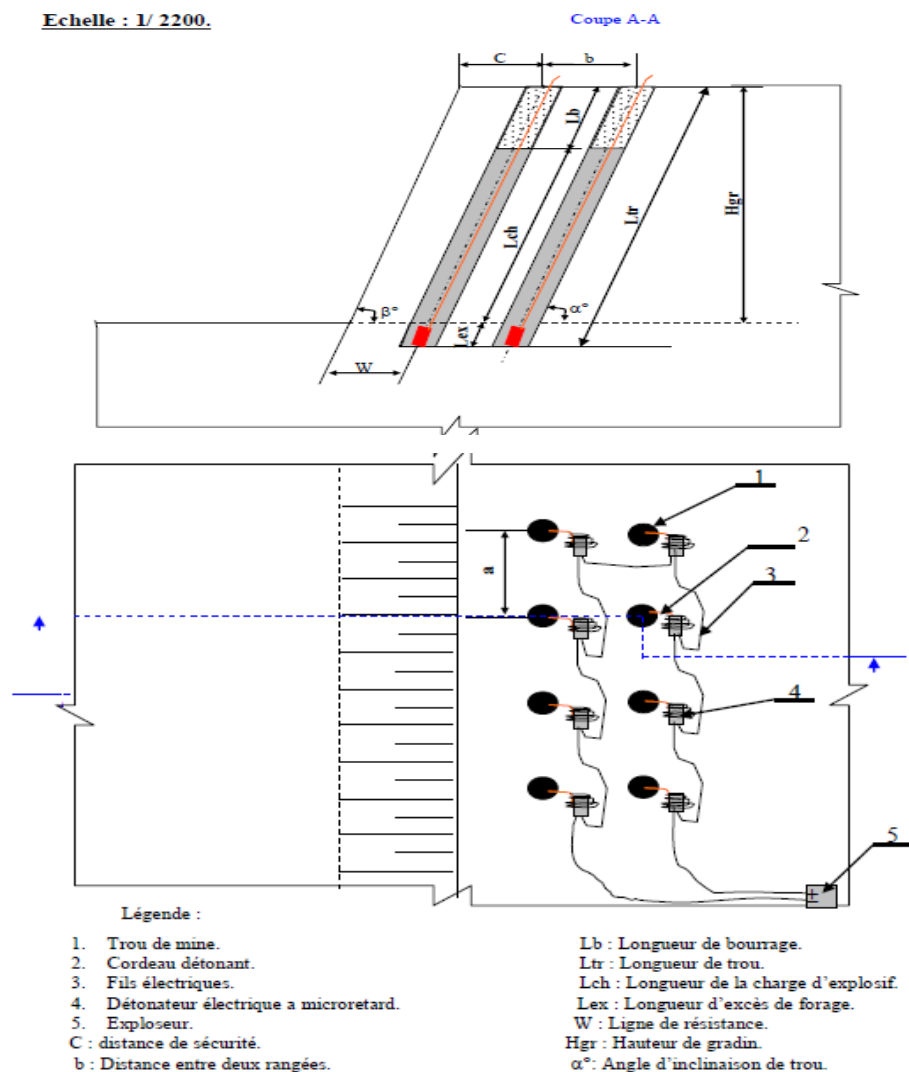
Exemple de plan de tir existant au niveau de la carrière Ain El Kébira
